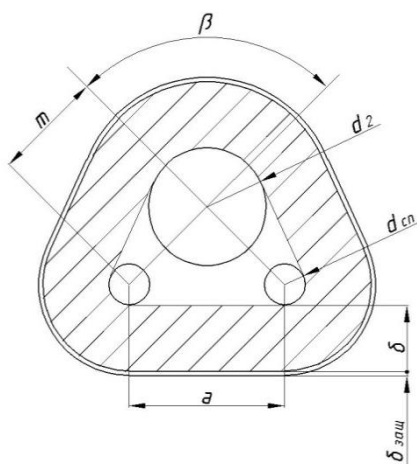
Изоляция трубопроводов с двумя теплопроводами-спутниками
